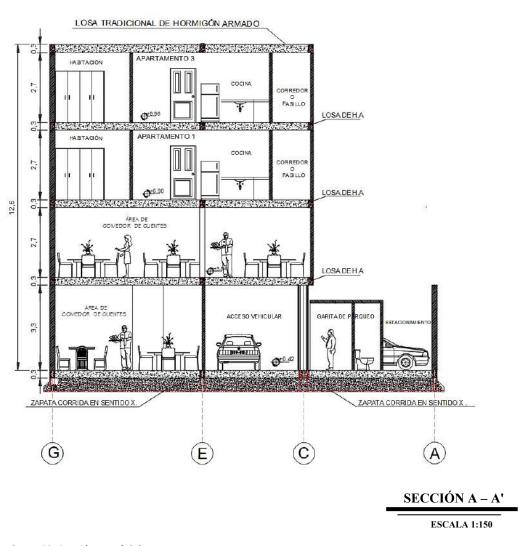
Sección A - A' del proyecto Fuente: Elaboración de autores.
